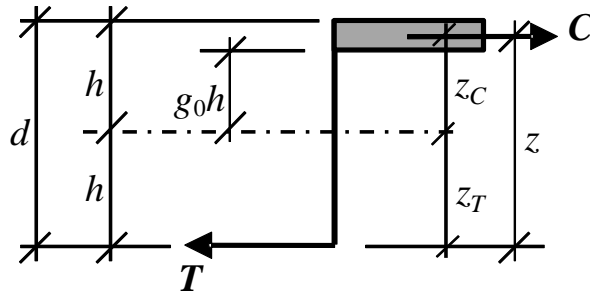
Calcul du moment résistant d'une dalle à ferrailage isotrope
